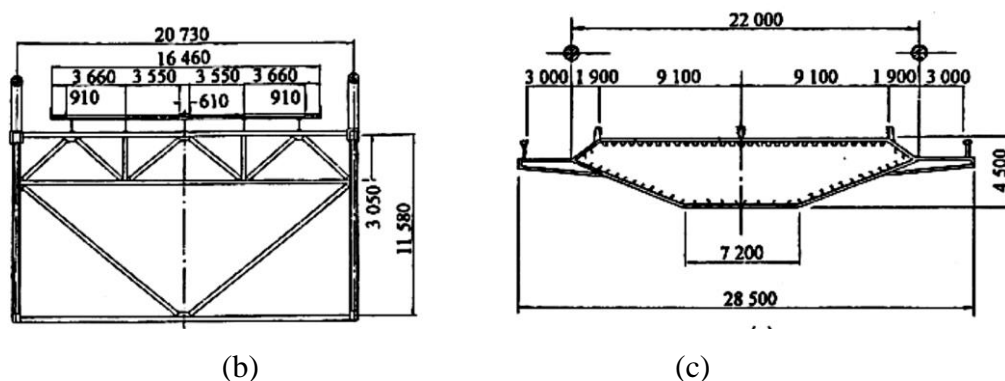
Lantai (*deck*) beton bertulang dan pelat baja ortotropik.
